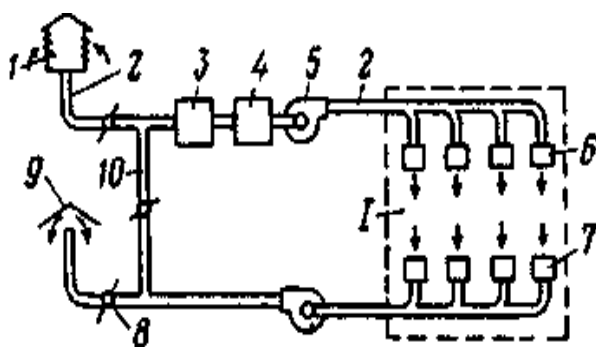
Схема приточно-вытяжной механической вентиляции:
